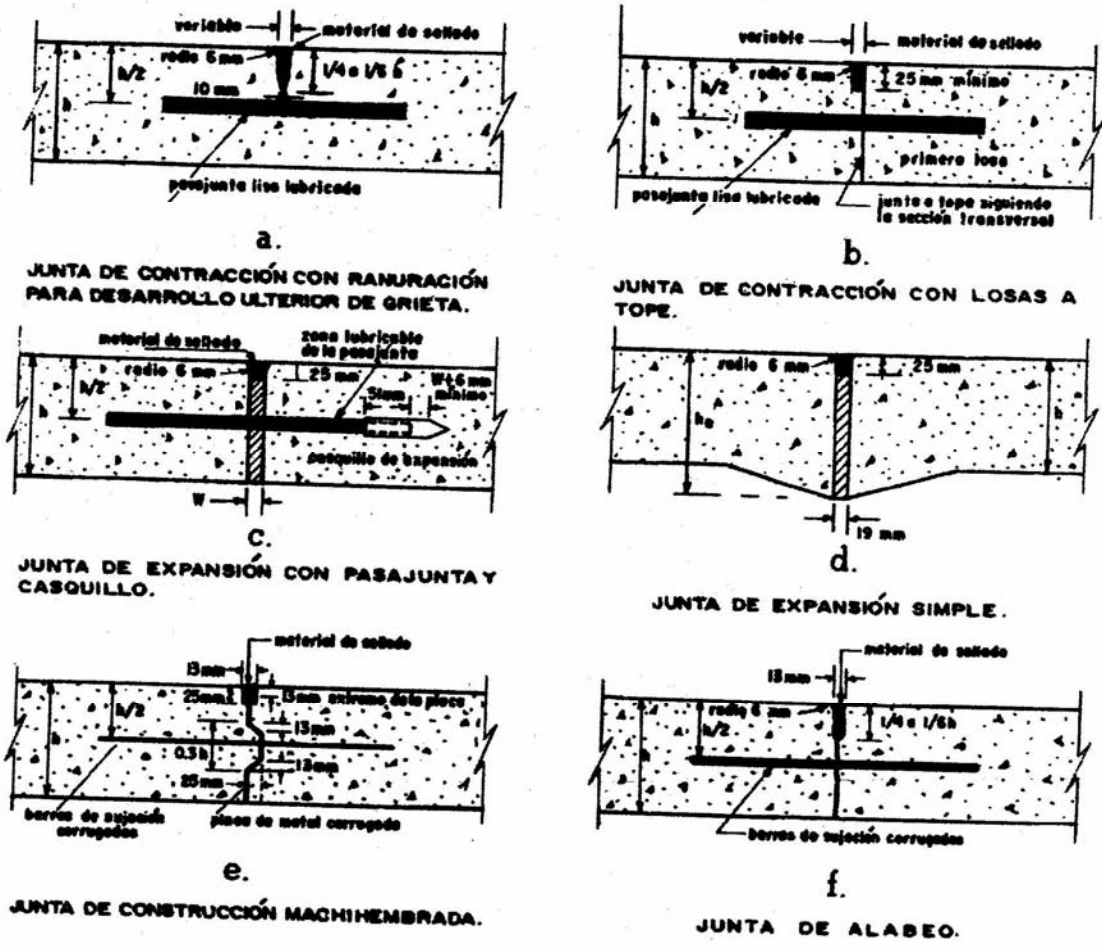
JUNTAS COMÚNES EN PAVIMENTOS RÍGIDOS.
